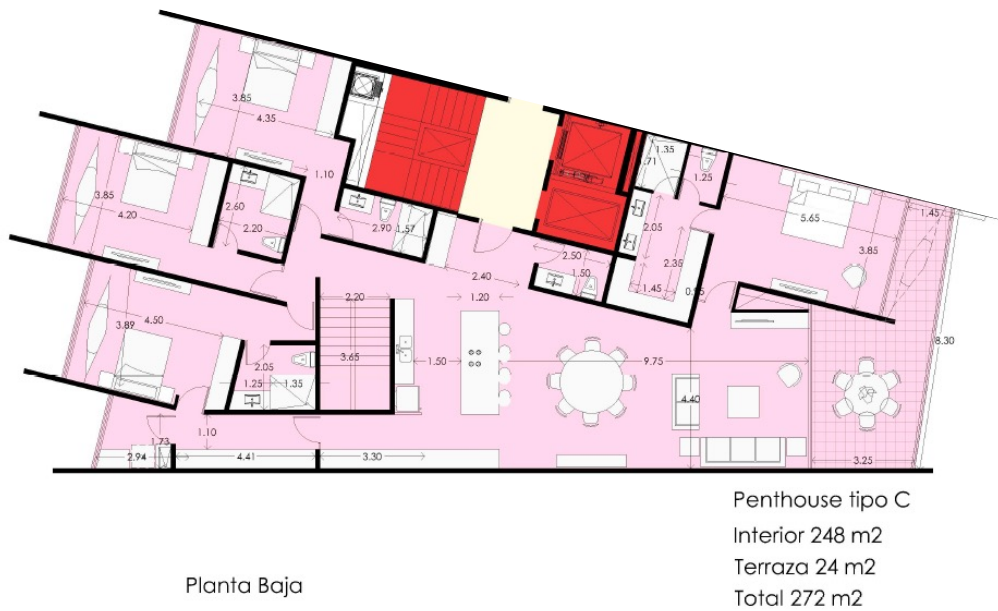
PLANTA BAJA PENTHOUSE TIPO C
